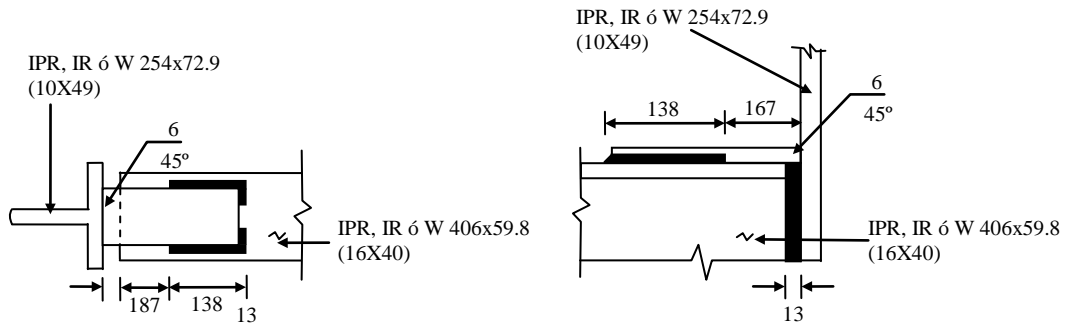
Disposición de soldaduras, acotaciones en mm.
